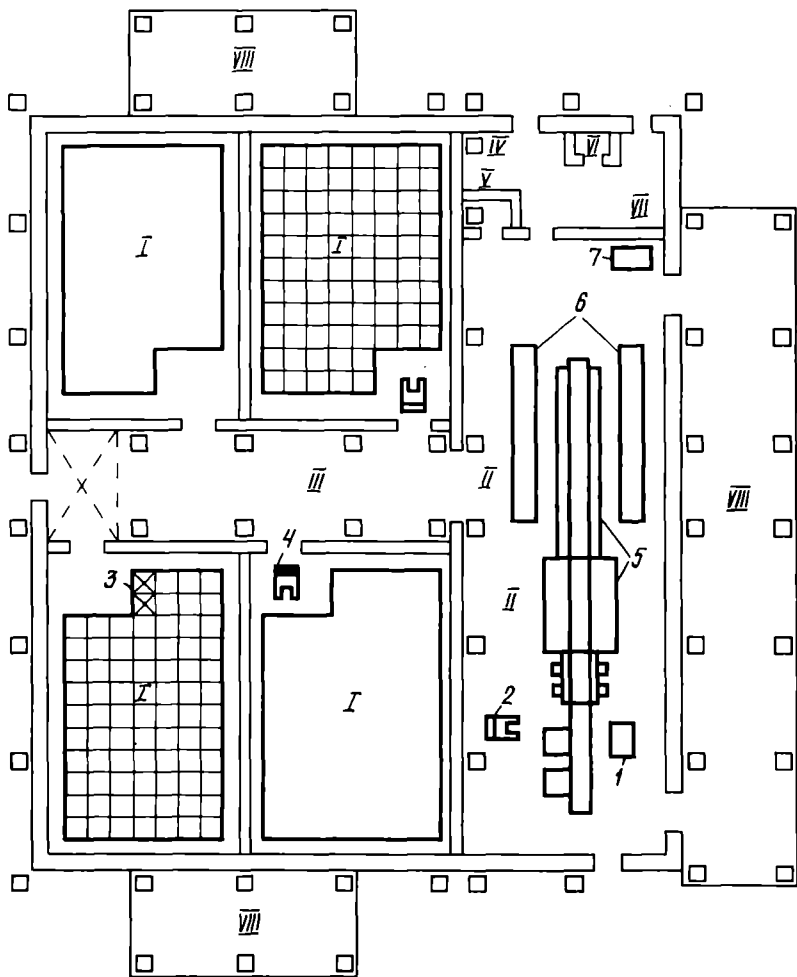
План плодохранилища (типовой проект 813—3—16.87):
